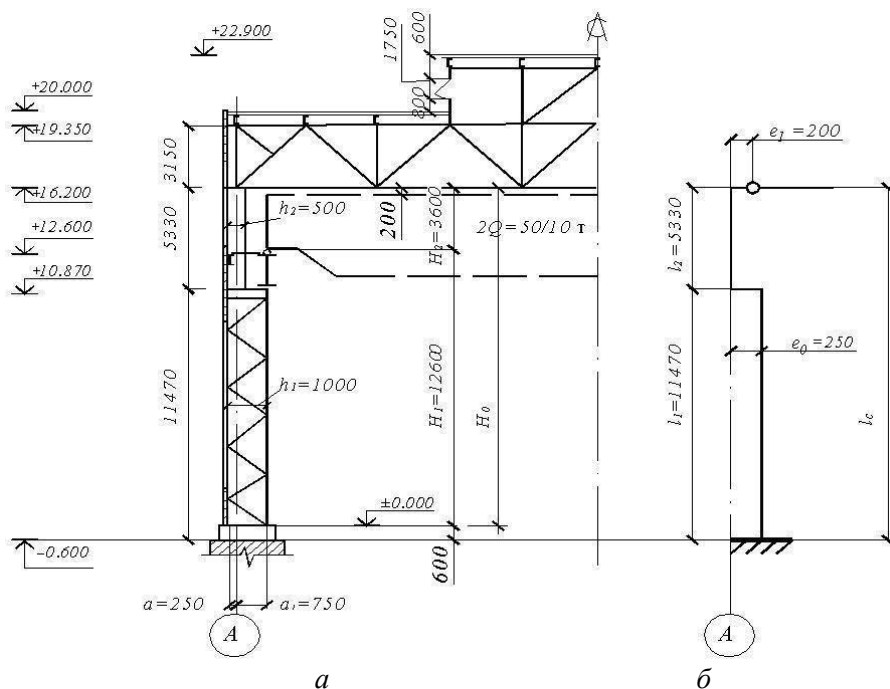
До прикладу 2.1: *a* – компоновальна схема поперечної рами; *б* – фрагмент розрахункової схеми рами
